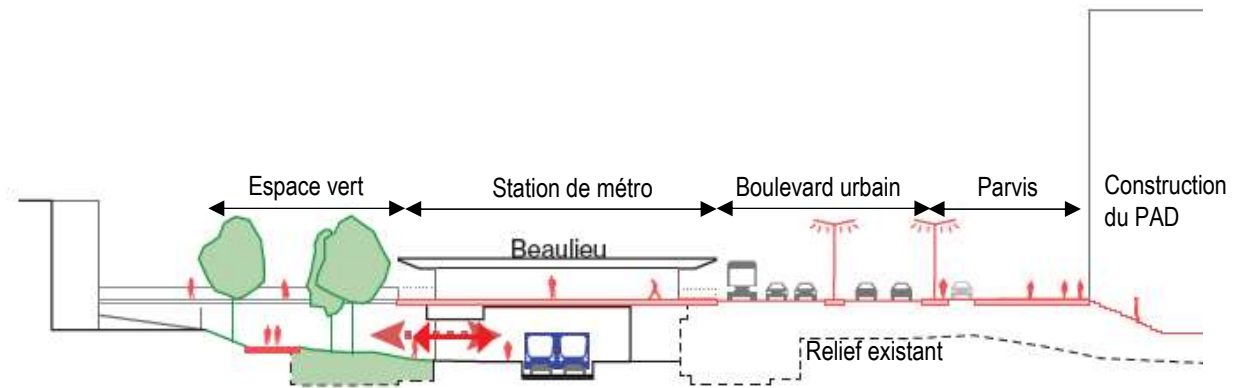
Profil de la place Beaulieu (ARIES sur fond ORG², 2018)
